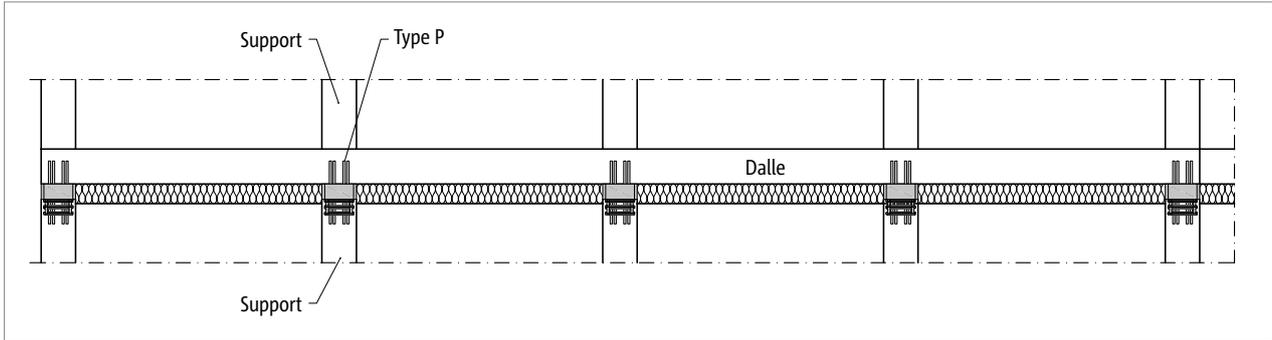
Schöck Sconnex® type P : raccordement du poteau à la dalle sus-jacente
